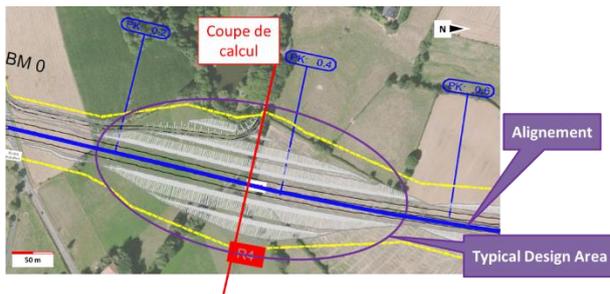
Vue en plan d'une zone type de dimensionnement – Ouvrage en remblai
